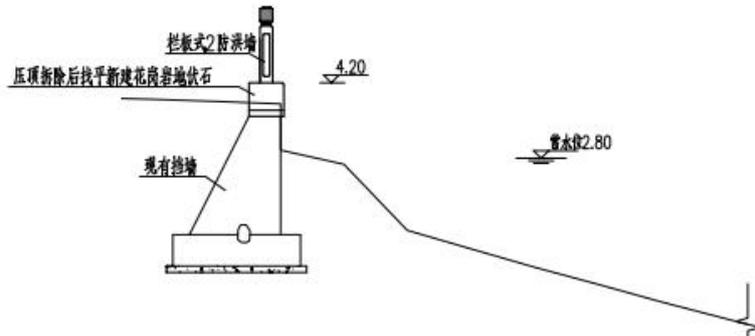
E型挡墙（钢筋砼防洪墙）断面图
